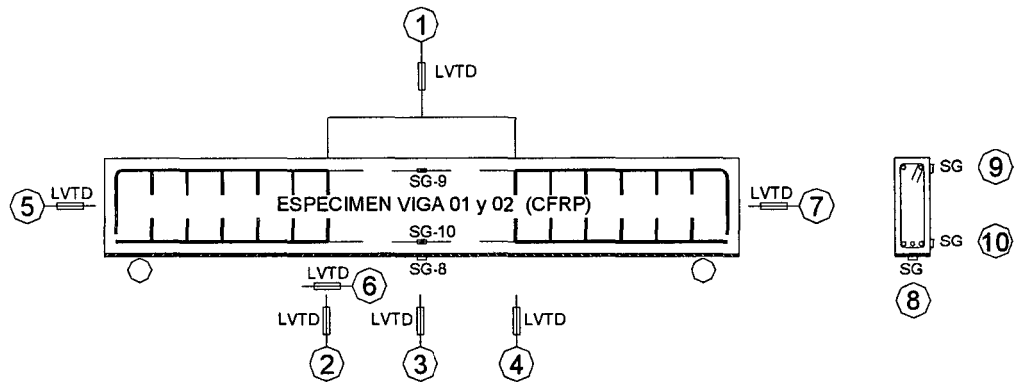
Ubicación de Transducer y Strain Gage en los espécimenes Viga 01 y 02 reforzadas con platinas fibra de carbono
